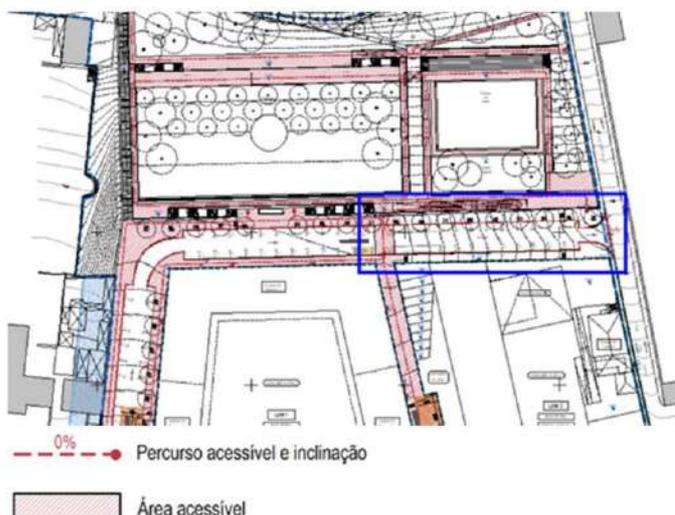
Plano de Acessibilidades - Planta Geral (desenho LOT-022 (R1), Maio 2023).
